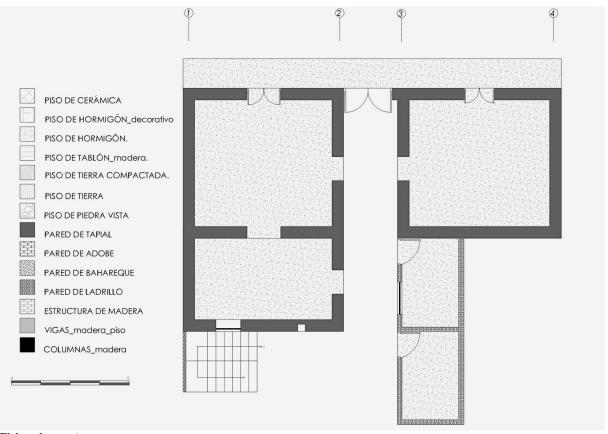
Planta arquitectónica 2º, vivienda modificada de un poblador oriundo 002
